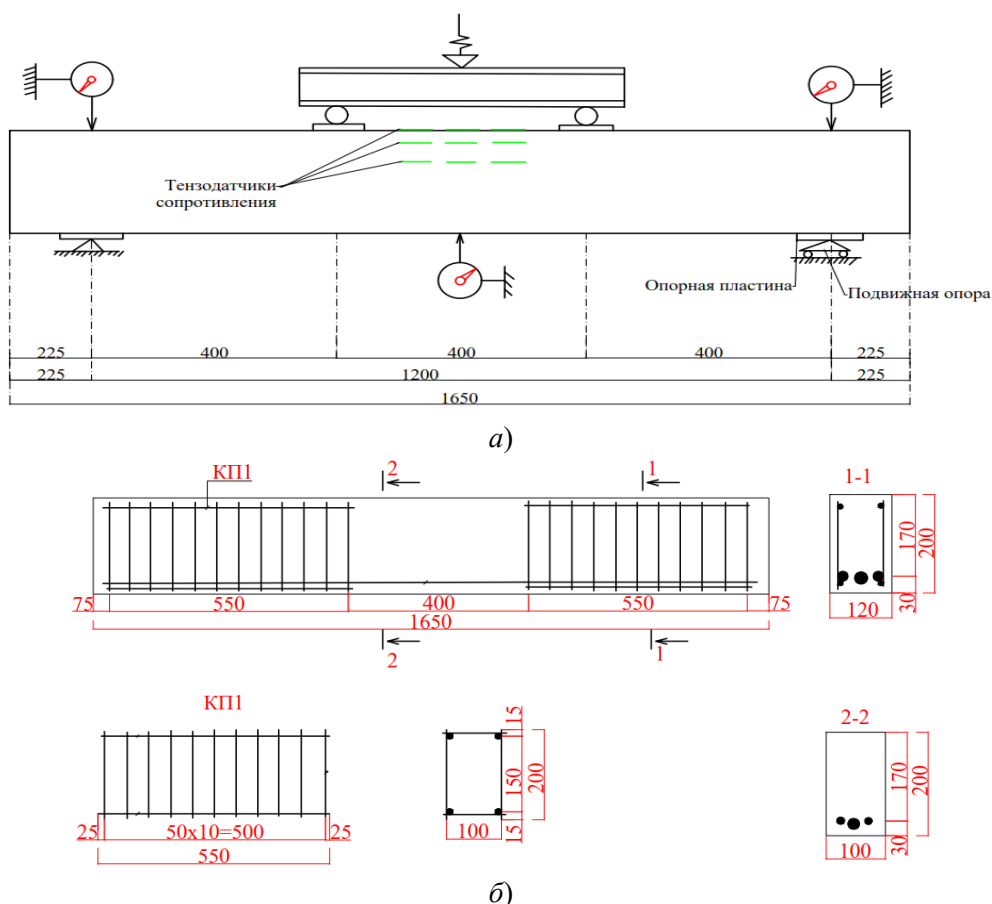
а) Схема испытания балок; б) Армирование железобетонных балок (иллюстрация автора)
